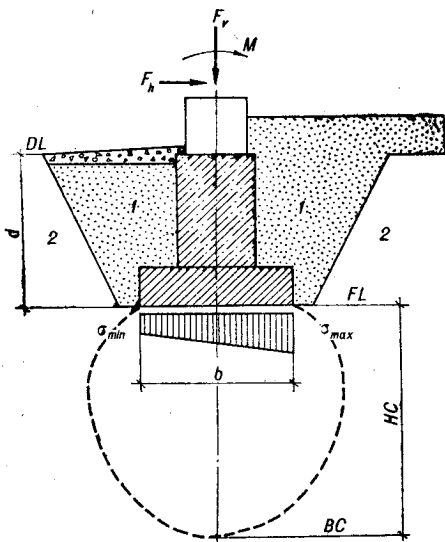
Схема взаємодії фундаменту, споруджуваного у відкритому котловані, з навколишнім ґрунтом:
